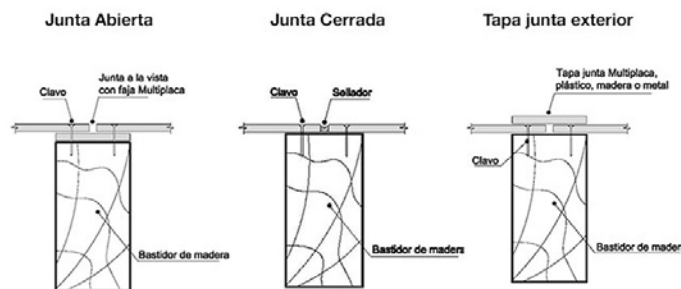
Tipos de juntas en placas de cierre de madera. Fuente: internet
